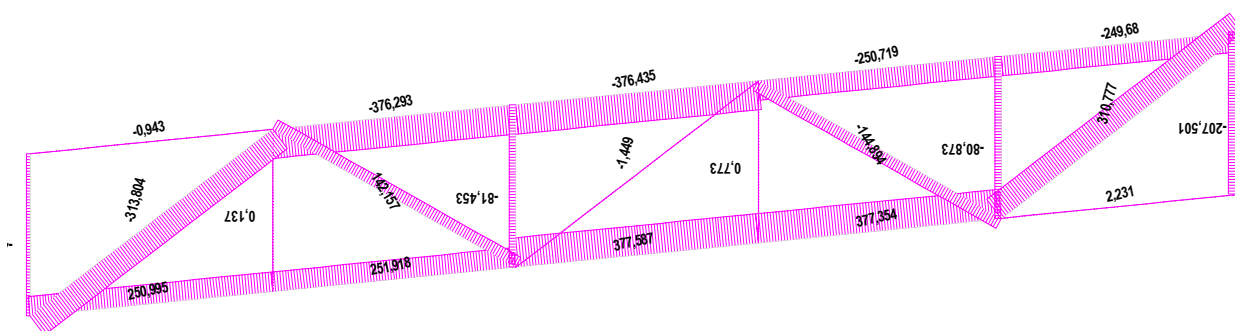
Эпюры усилий в стержнях фермы
